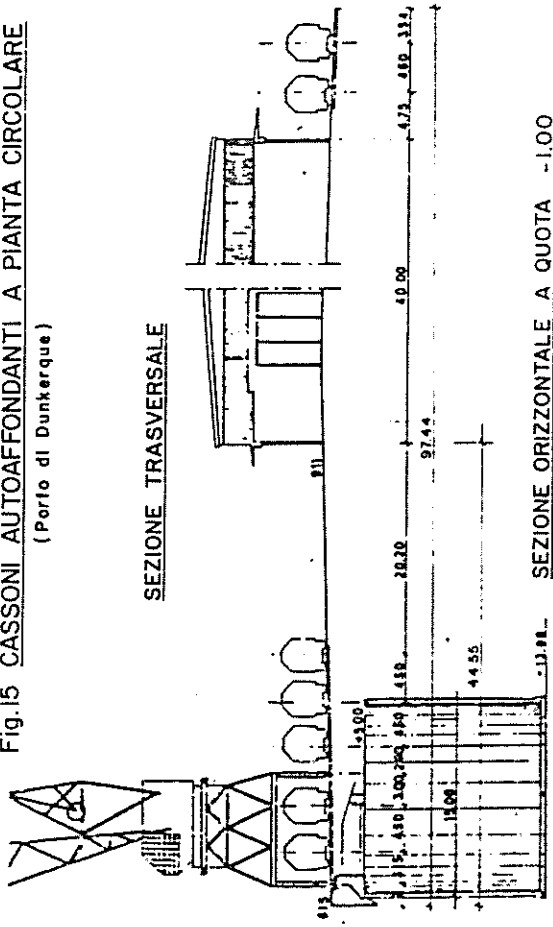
CASSONI AUTOAFFONDANTI A PIANTA CIRCOLARE
